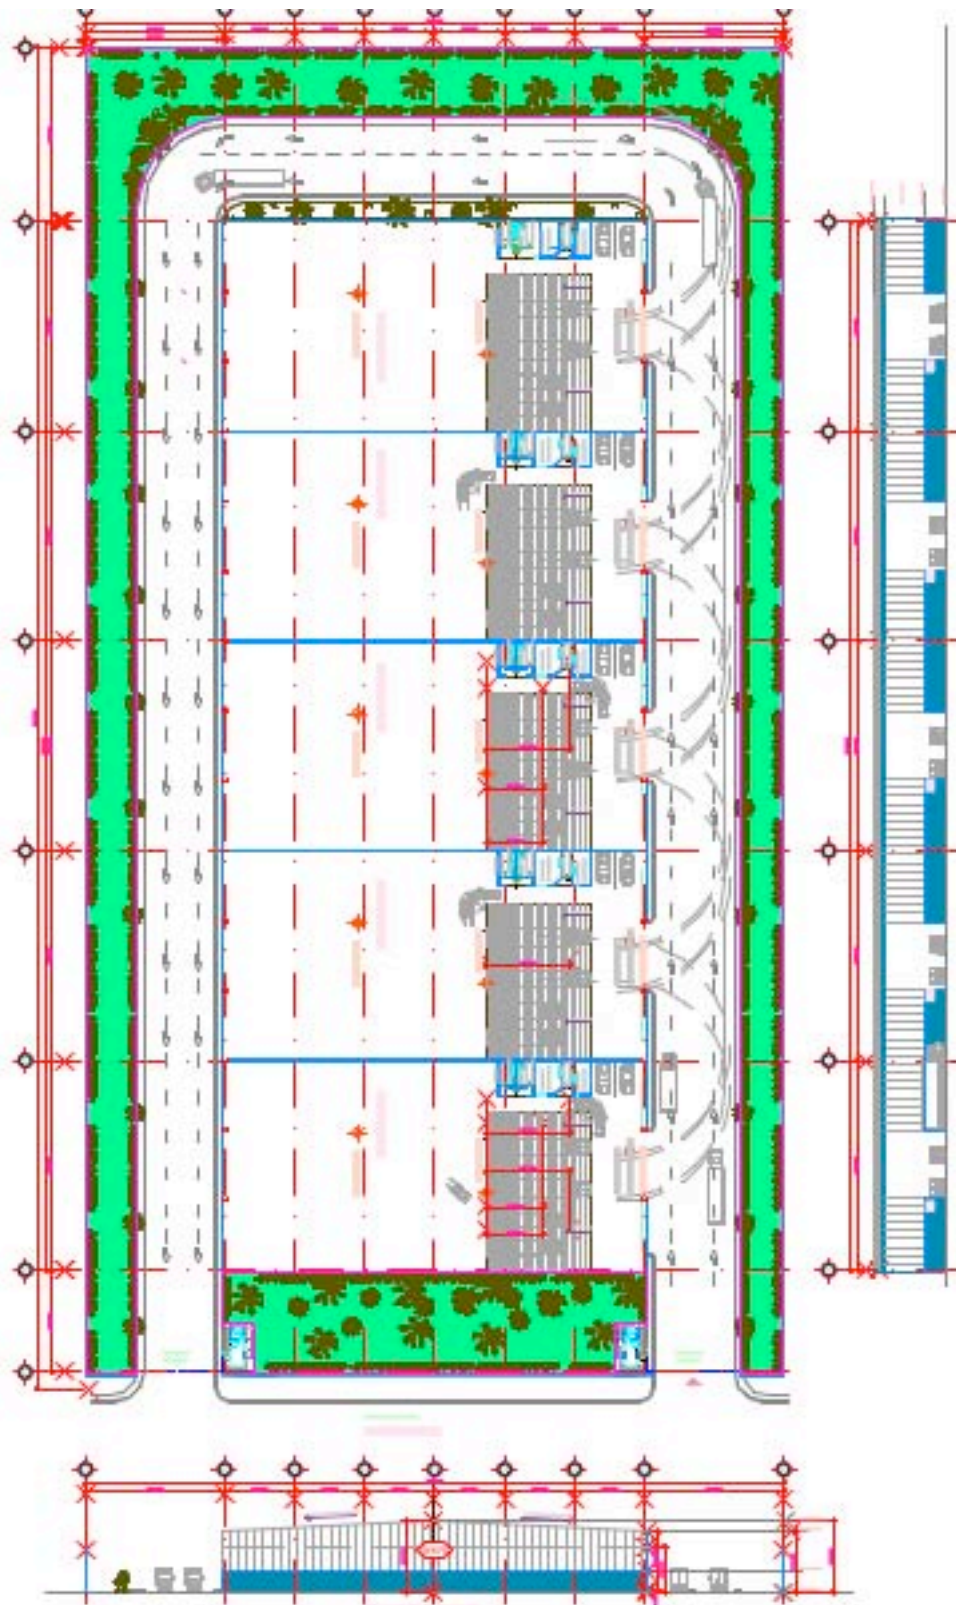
Planta Arquitectónica tipo del conjunto de naves
